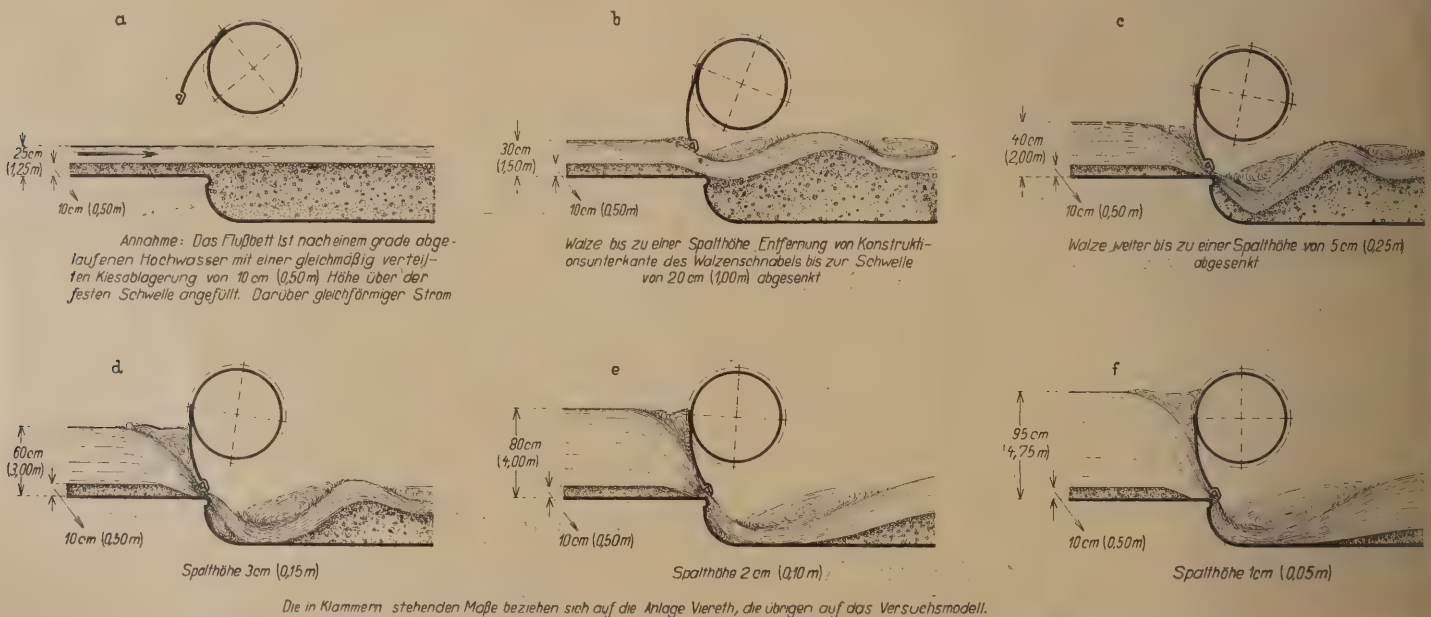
Modellversuche mit einer teilweise versenkbaren Walze, Geschiebeablagerung und Geschiebeabführung.
